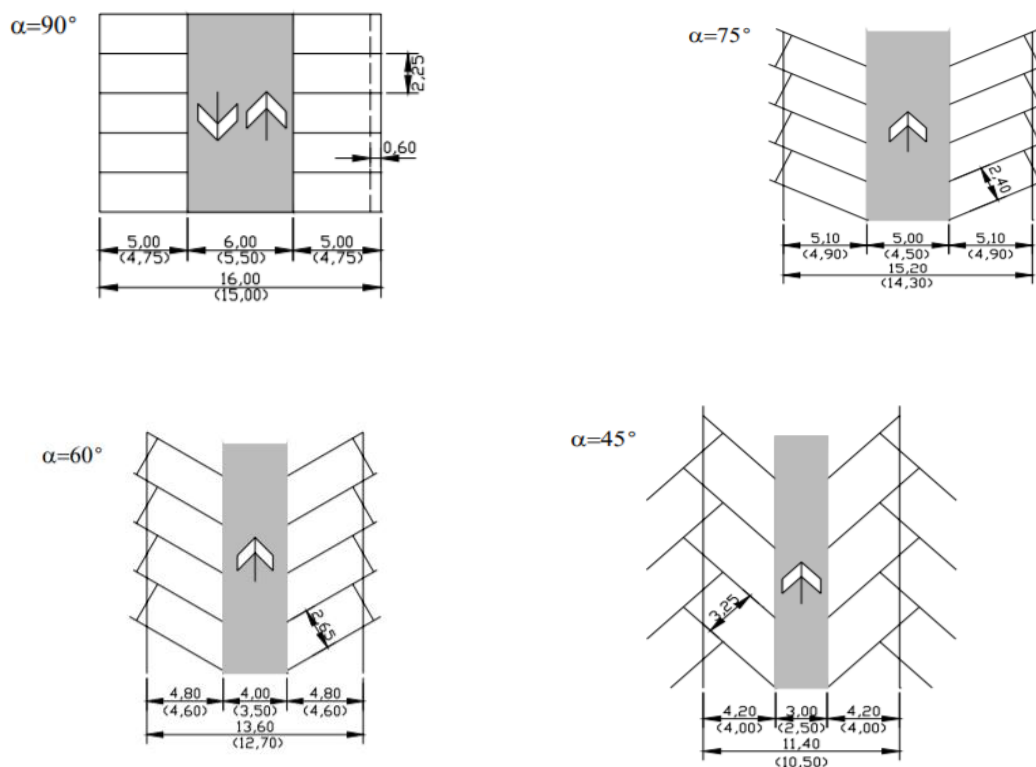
Dimenzije crta za označavanje mjesta za parkiranje, [1]
